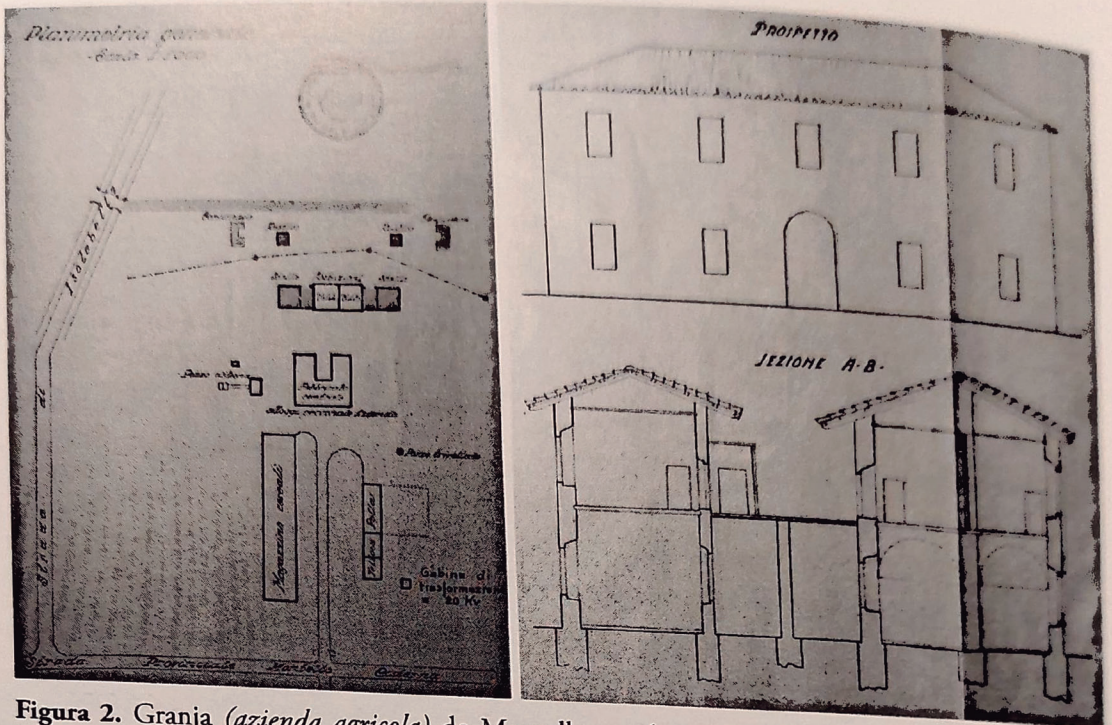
Granja (*azienda agricola*) de Montello en el entorno de Borgo Isollabella. Planta del conjunto y alzado de edificación. Fuente: ACSR/ONC/AP, busta 63, progetto 147.
